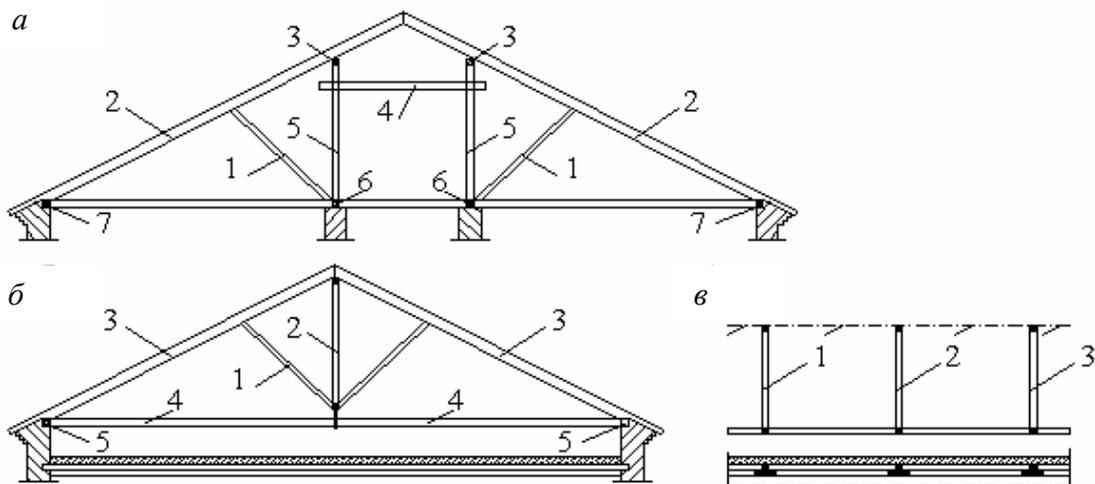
Последовательность разборки висячих стропил (а, б) и спускания стропильных ферм на чердачные перекрытия (в): 1 – 6 – последовательность разборки
